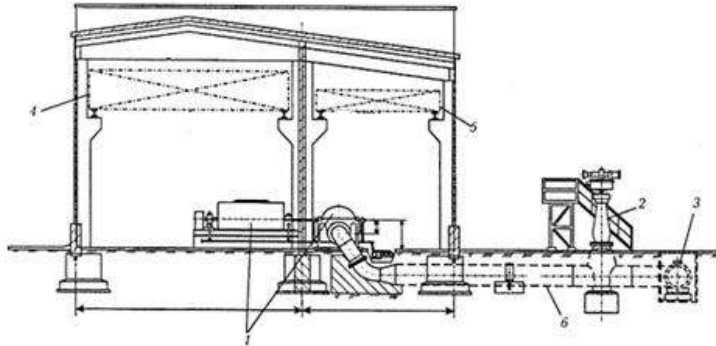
Насосный цех, оборудованный насосными агрегатами НМ-10000-210: 1 – насос с электродвигателем; 2 – задвижка с электроприводом; 3 – клапан обратный; 4 – кран мостовой ручной двухбалочный; 5 – кран ручной мостовой однобалочный; 6 – технологический трубопровод
